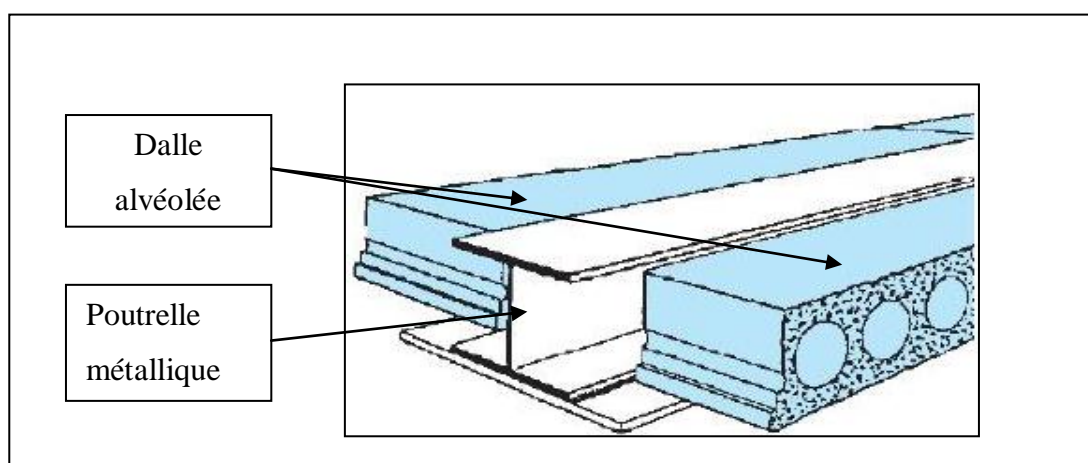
Plancher à poutrelles intégrées ou plancher avec poutres à talon.⁴⁵
